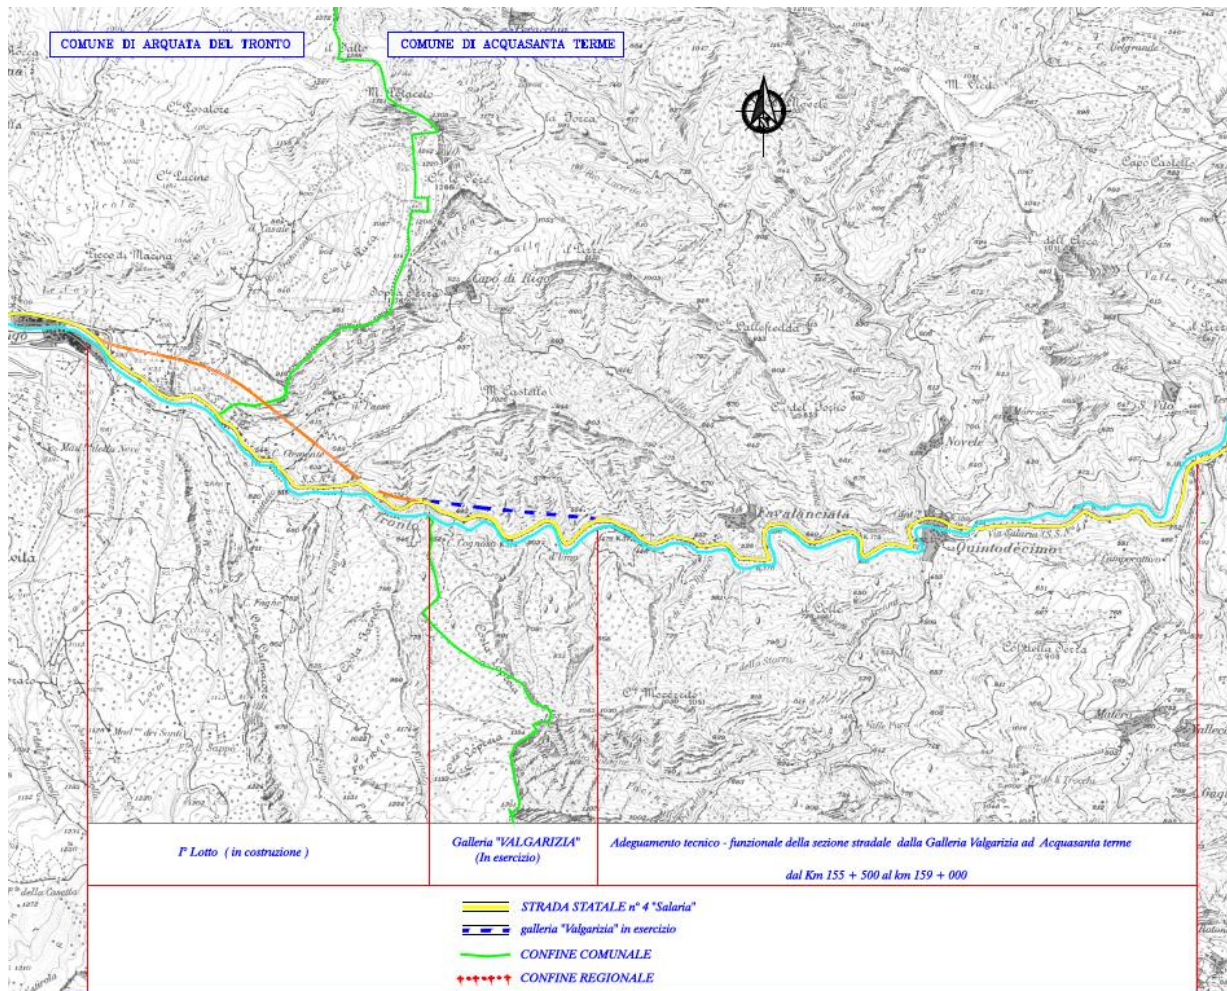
AN 544 – SS 4 "Via Salaria" - Piano di potenziamento e riqualificazione - Interventi di adeguamento e miglioramento tecnico-funzionale della sezione stradale in tratti saltuari dal km 155+750 al km 159+000 - Estratto planimetrico – Inquadramento Territoriale
